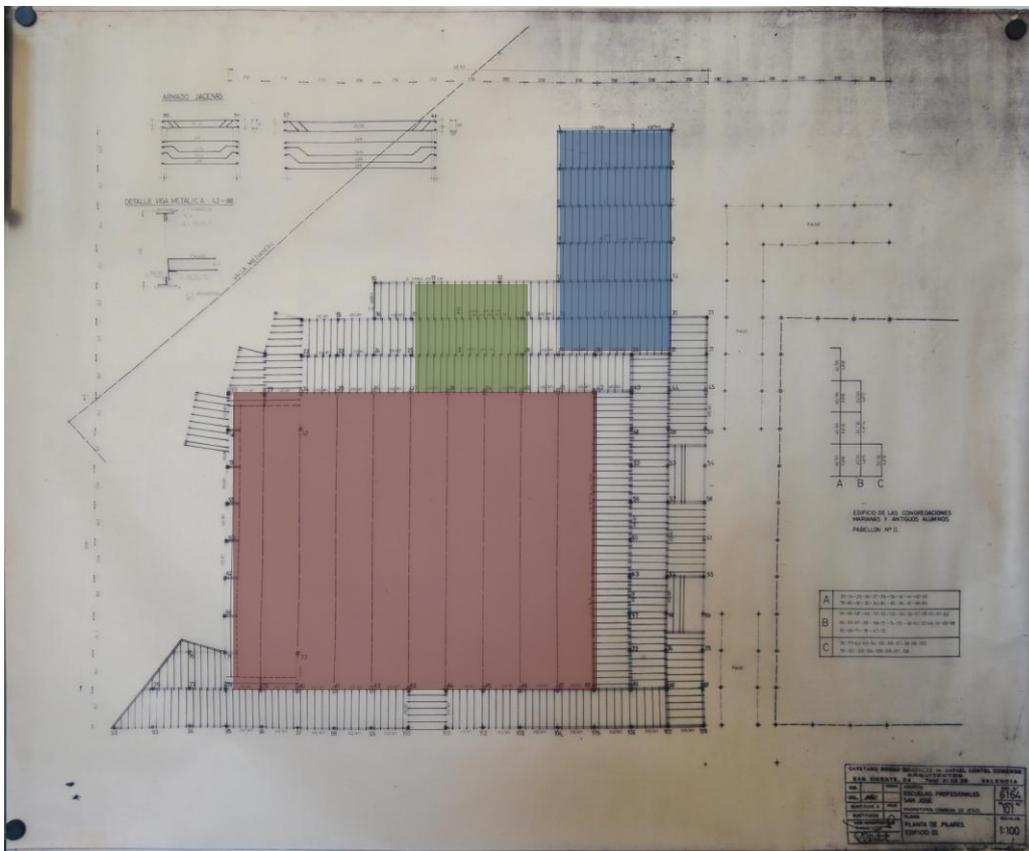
Planta de estructuras del salón de actos. Archivo Escuelas San José.
